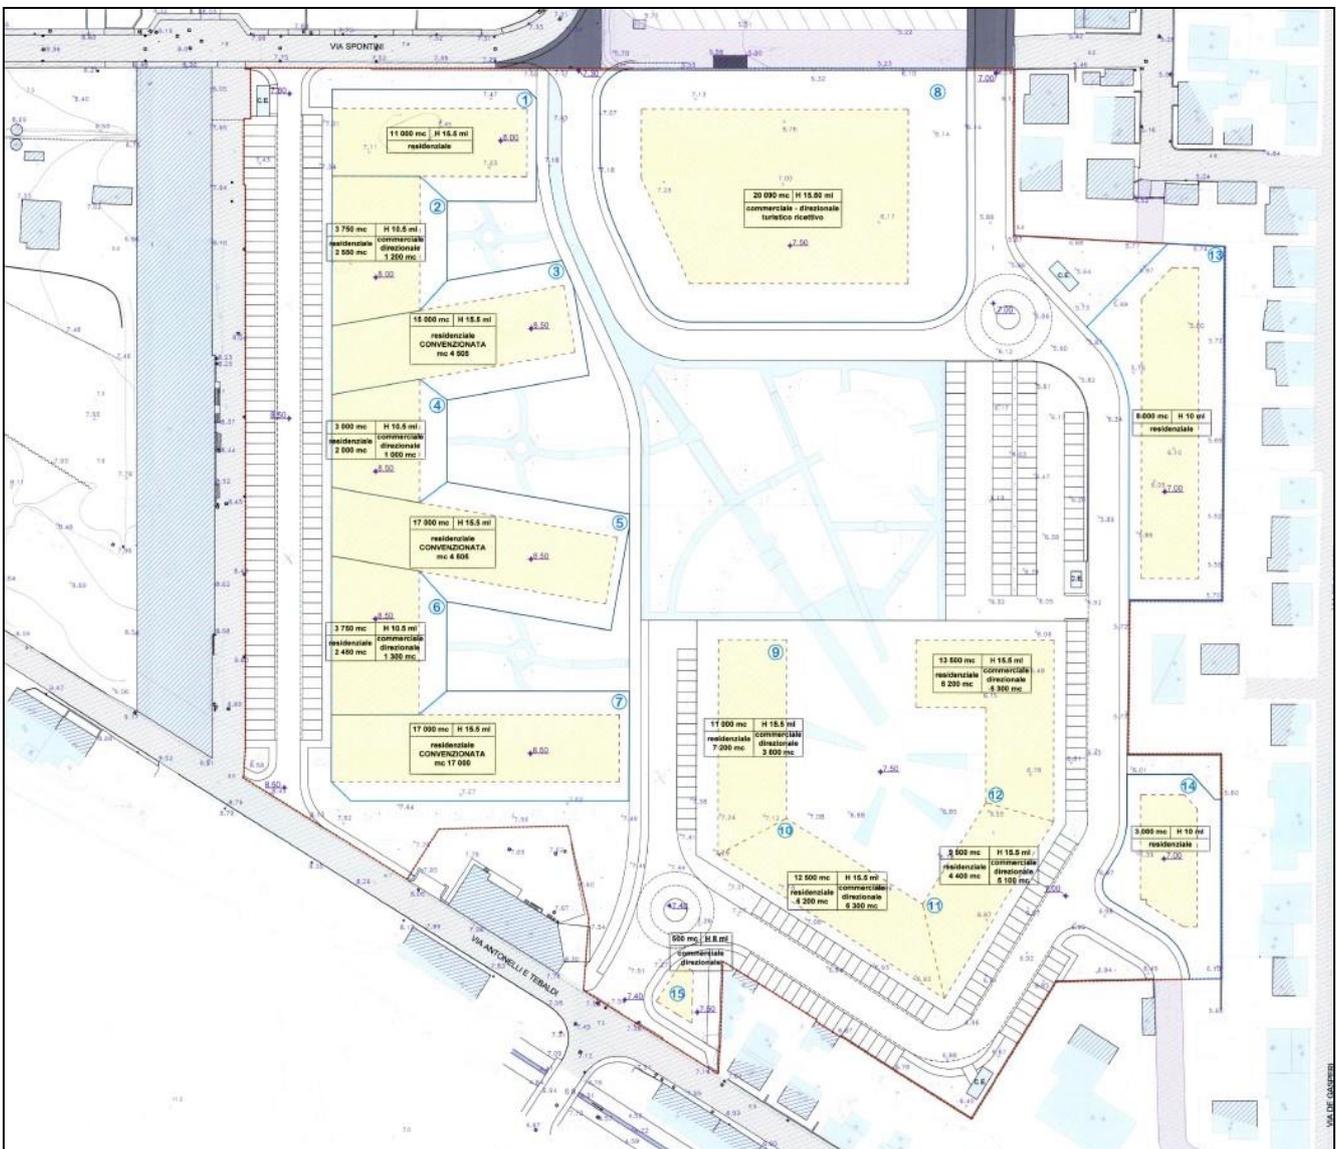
Stralcio Tav. 4 ottobre 2010 Variante 1 al PP3 ai sensi della L.R. 22/2009
